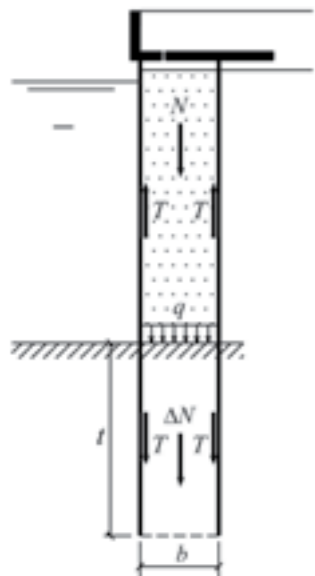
Схема передачи веса межстенной засыпки на грунт основания
